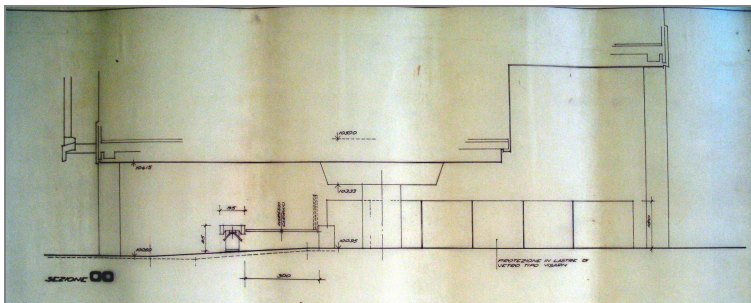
tornelli ingresso principale – sezione (fonte CSAC – stralcio tav. 118, archivio n. 384-3)
